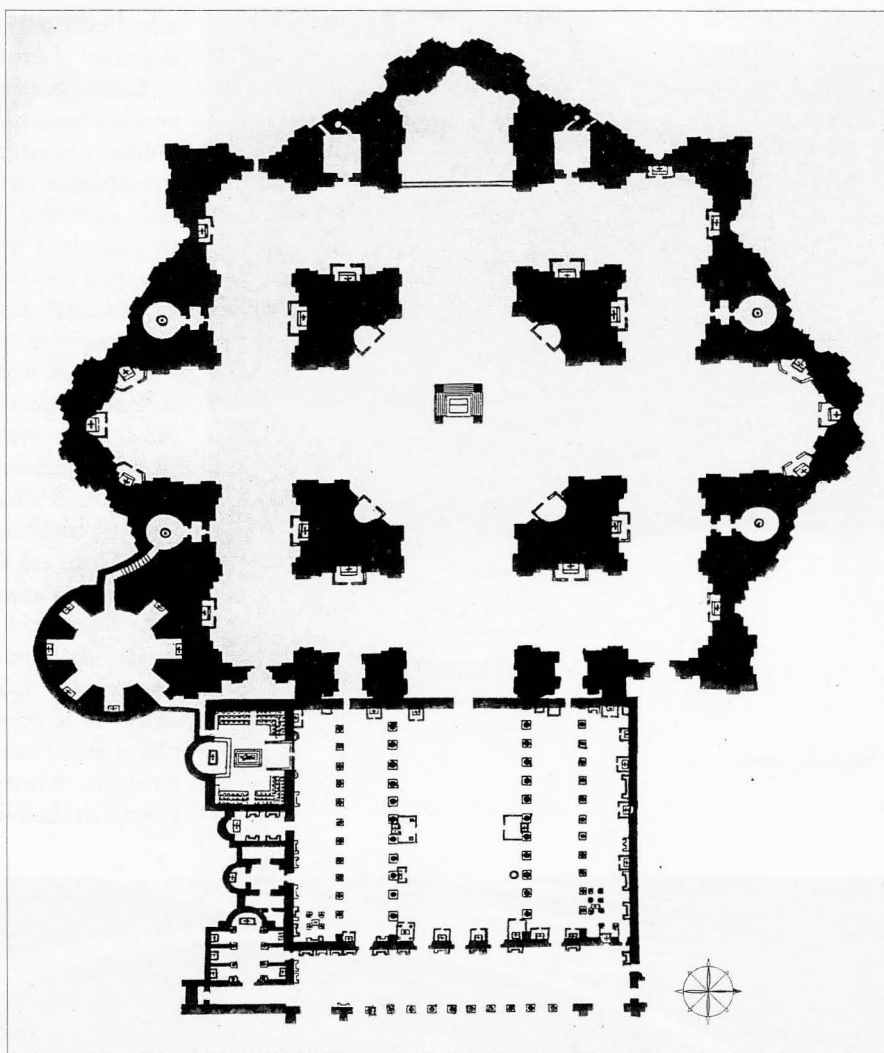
Pianta di S. Pietro, ca. 1600 (ricostruzione dell'A.).
